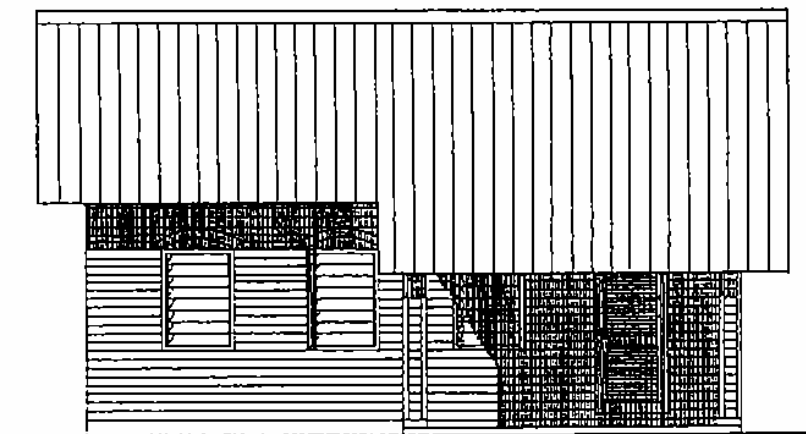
Élévation d'une façade pignon et d'une façade principale de la salle de classe.
